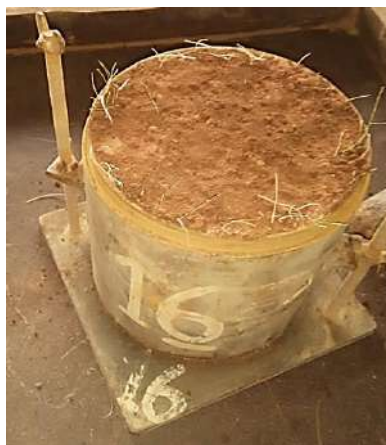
Colocado de las capas de suelo con PET para la compactación.
